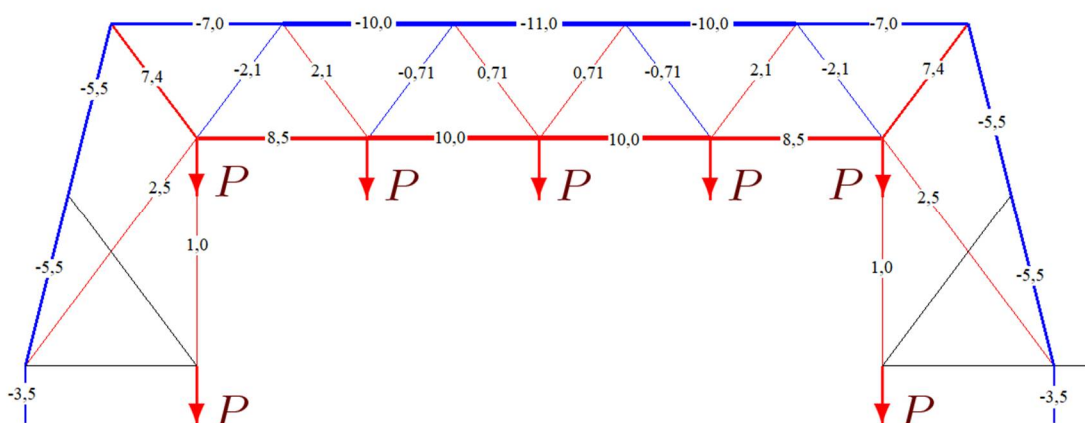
Усилия в стержнях фермы в случае нагрузки по нижнему поясу
